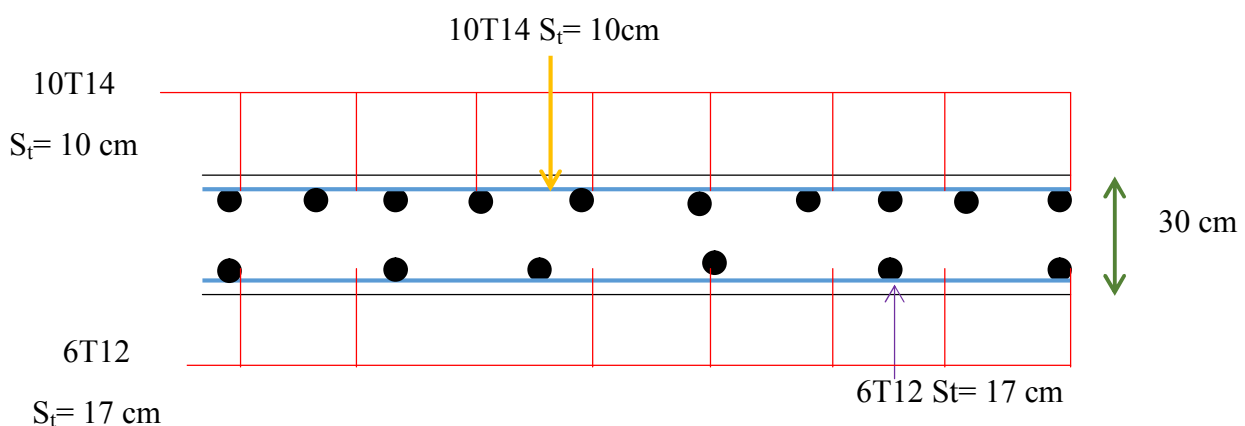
Ferrailage de la dalle du radier en BO pour une bande de 1m
